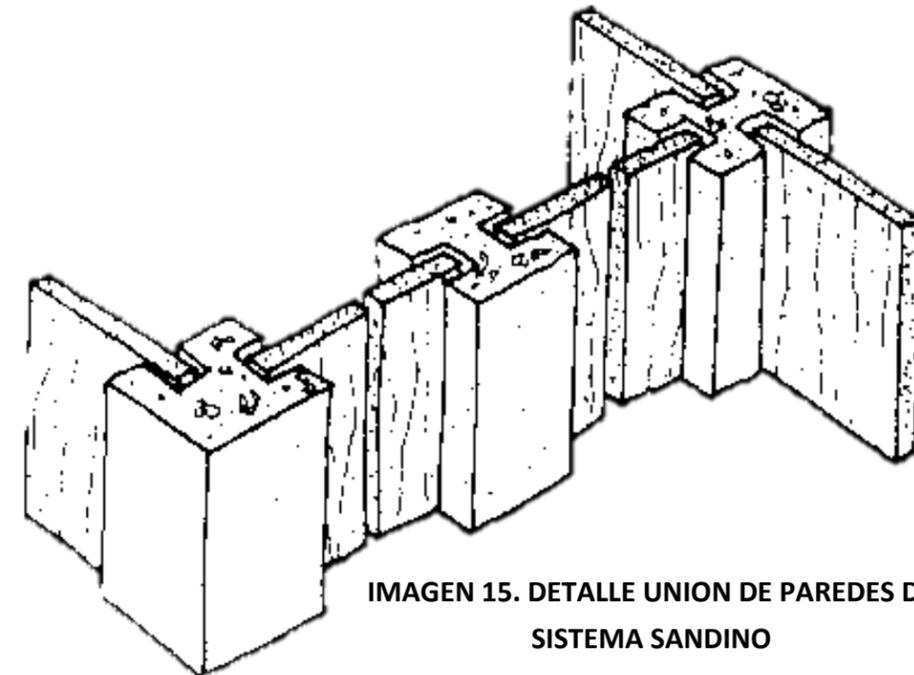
DETALLE UNION DE PAREDES DE SISTEMA SANDINO
